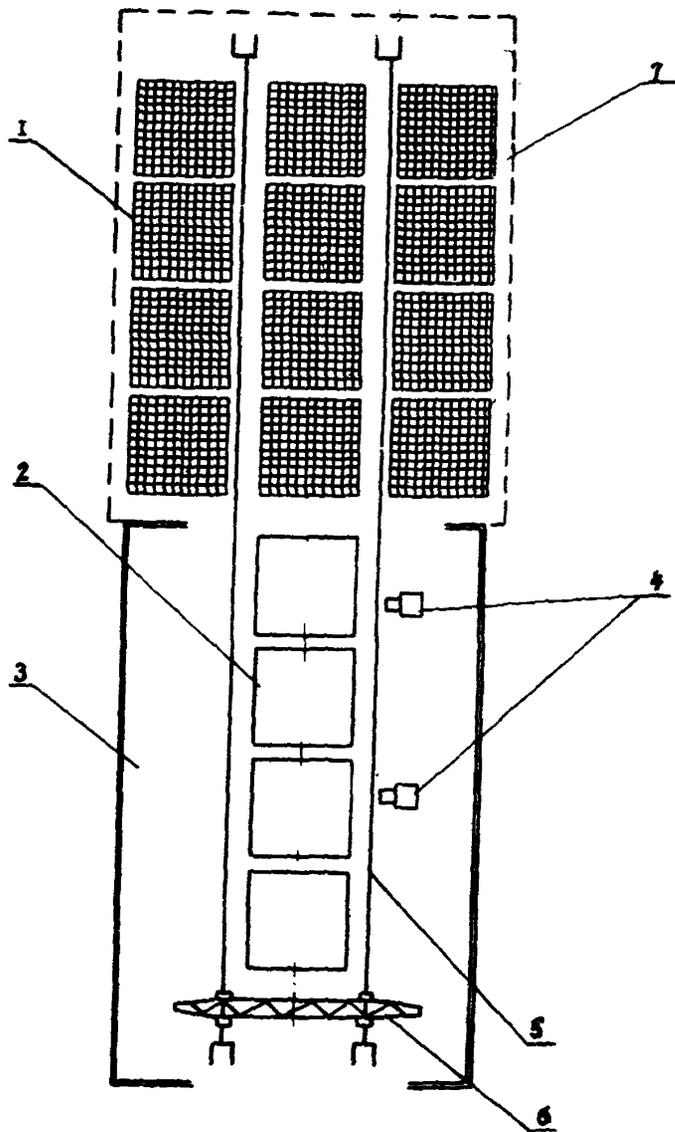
Схема арматурного цеха с неподвижными кондукторами:
